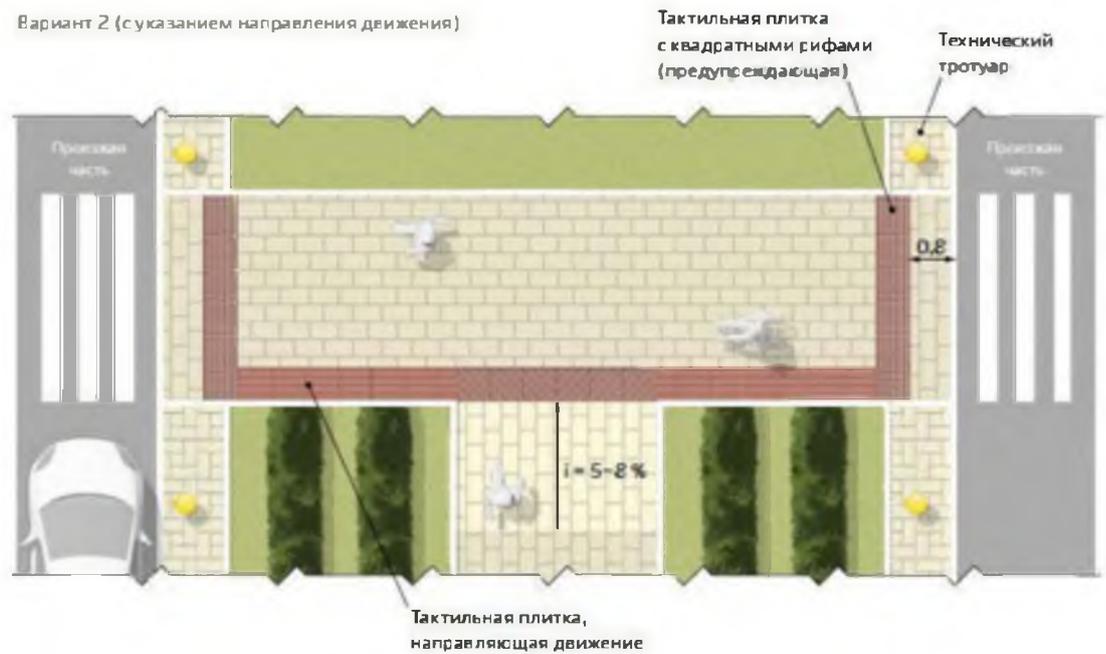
Размещение тактильных плит на пешеходных тротуарах, расположенных на уровне проезжей части (вариант 1,2)
